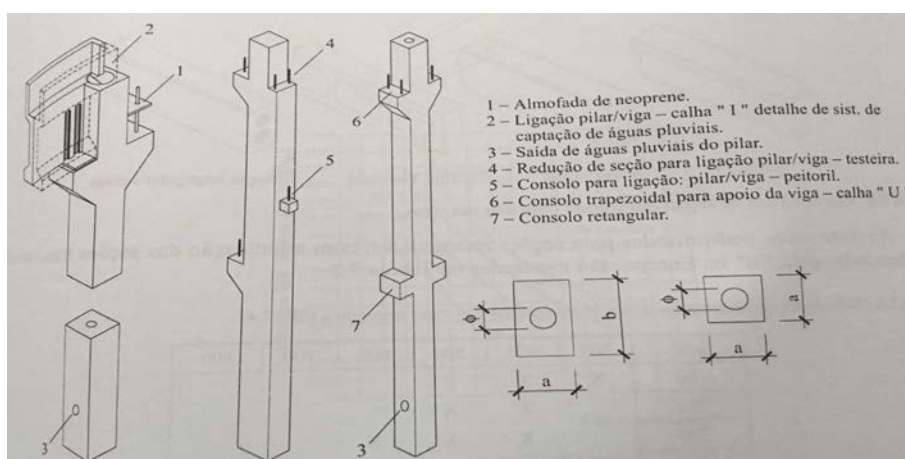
Formas de Pilares mais utilizadas ao longo de seu comprimento
